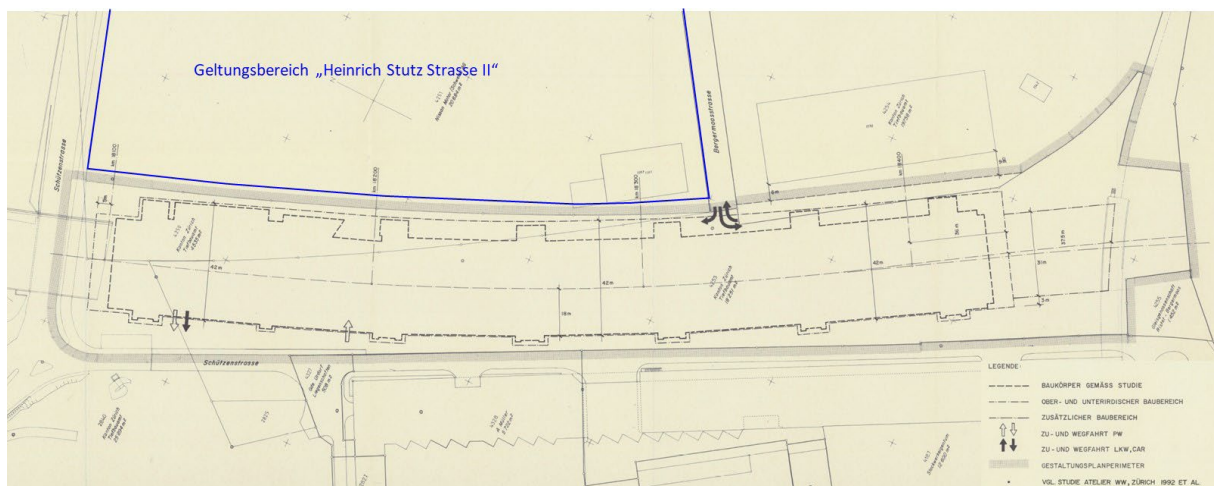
Ausschnitt Situationsplan Bergermoos III, GP „Heinrich Stutz Strasse II“ blau markiert
